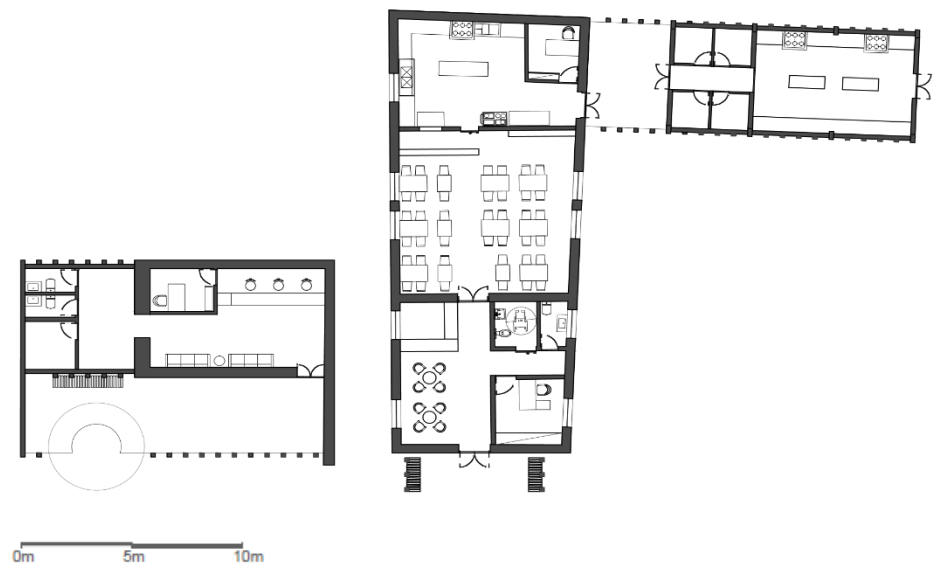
Planta | Recepção, Restaurante, Edifício adjacente à antiga adegas
